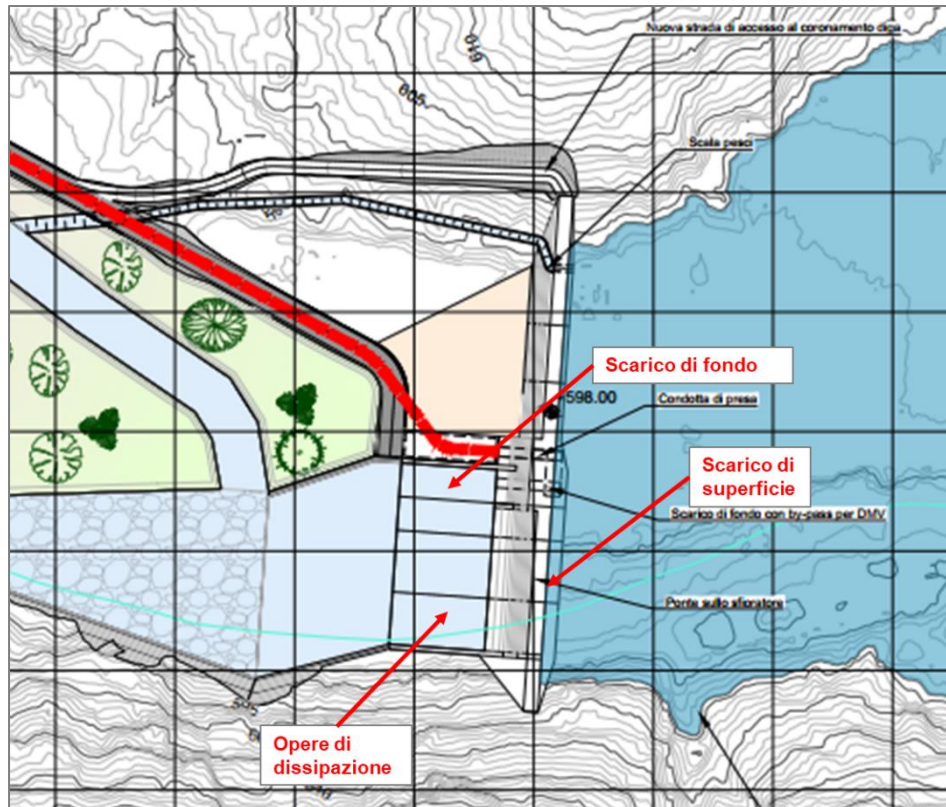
Alternativa 3: planimetria di inquadramento della Diga A2
